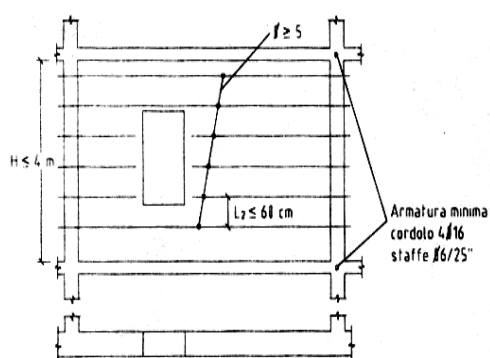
Armatura orizzontale minima (caso $H = 4.00$ m)
